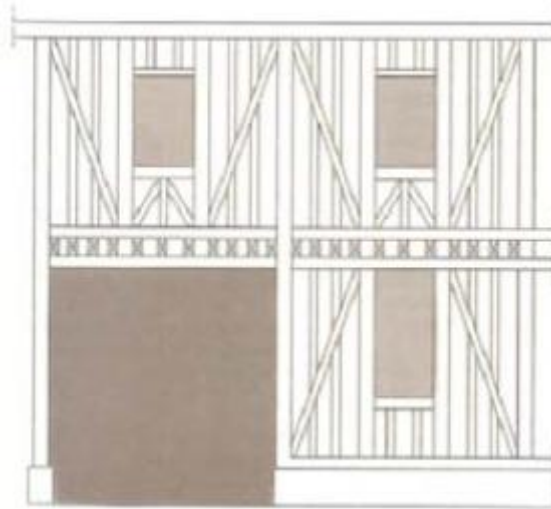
Estrutura em Timber Frame. Fonte: (Vaz, 2010).
